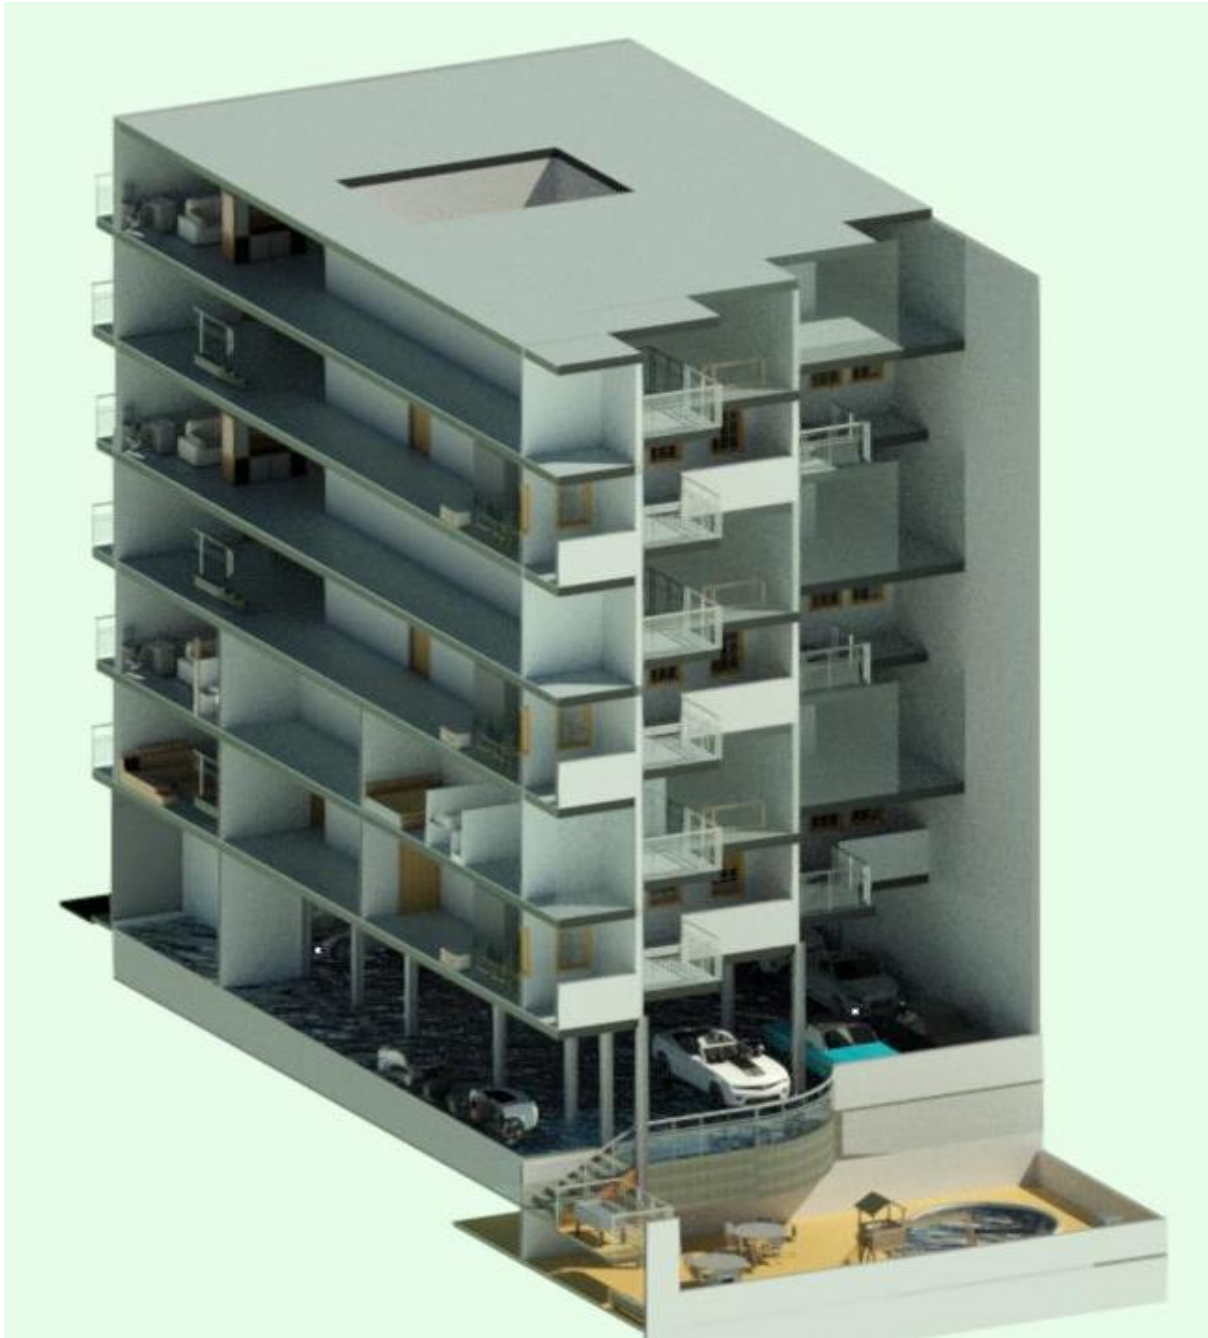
Corte longitudinal de proyecto arquitectónico.
